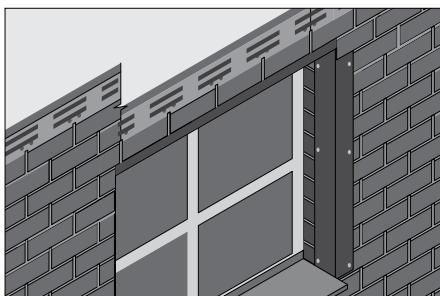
Монтаж фасадной плитки поверх оконного наличника сверху проема
